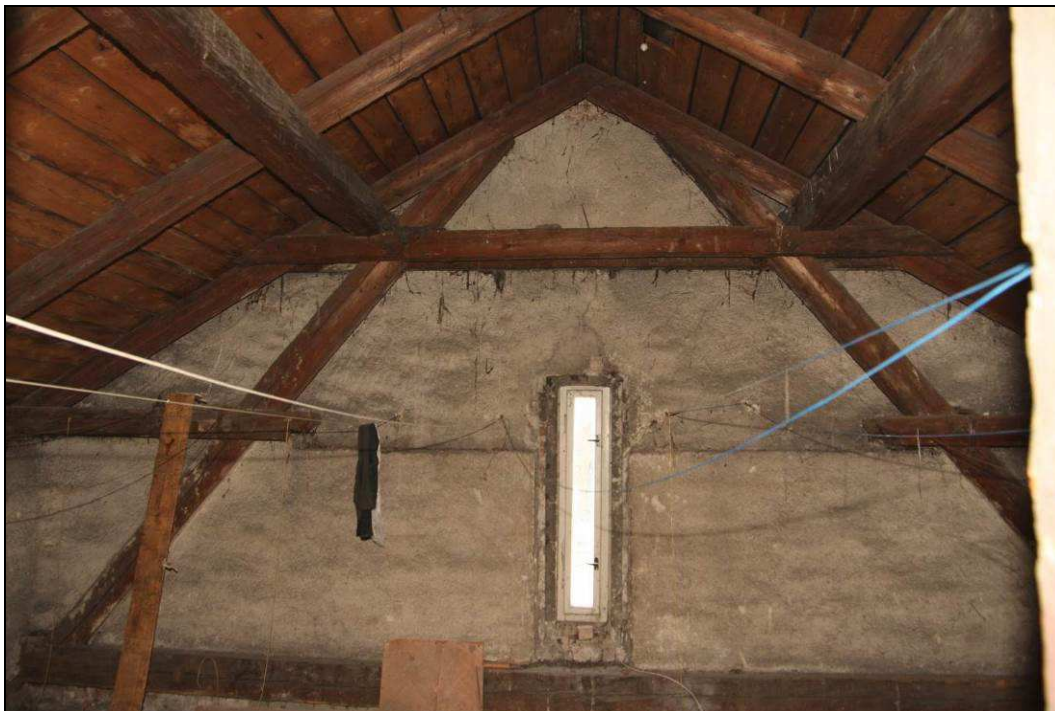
Prohlídka krovu - pravá část, detail lokálně vyměněné části pozednice
